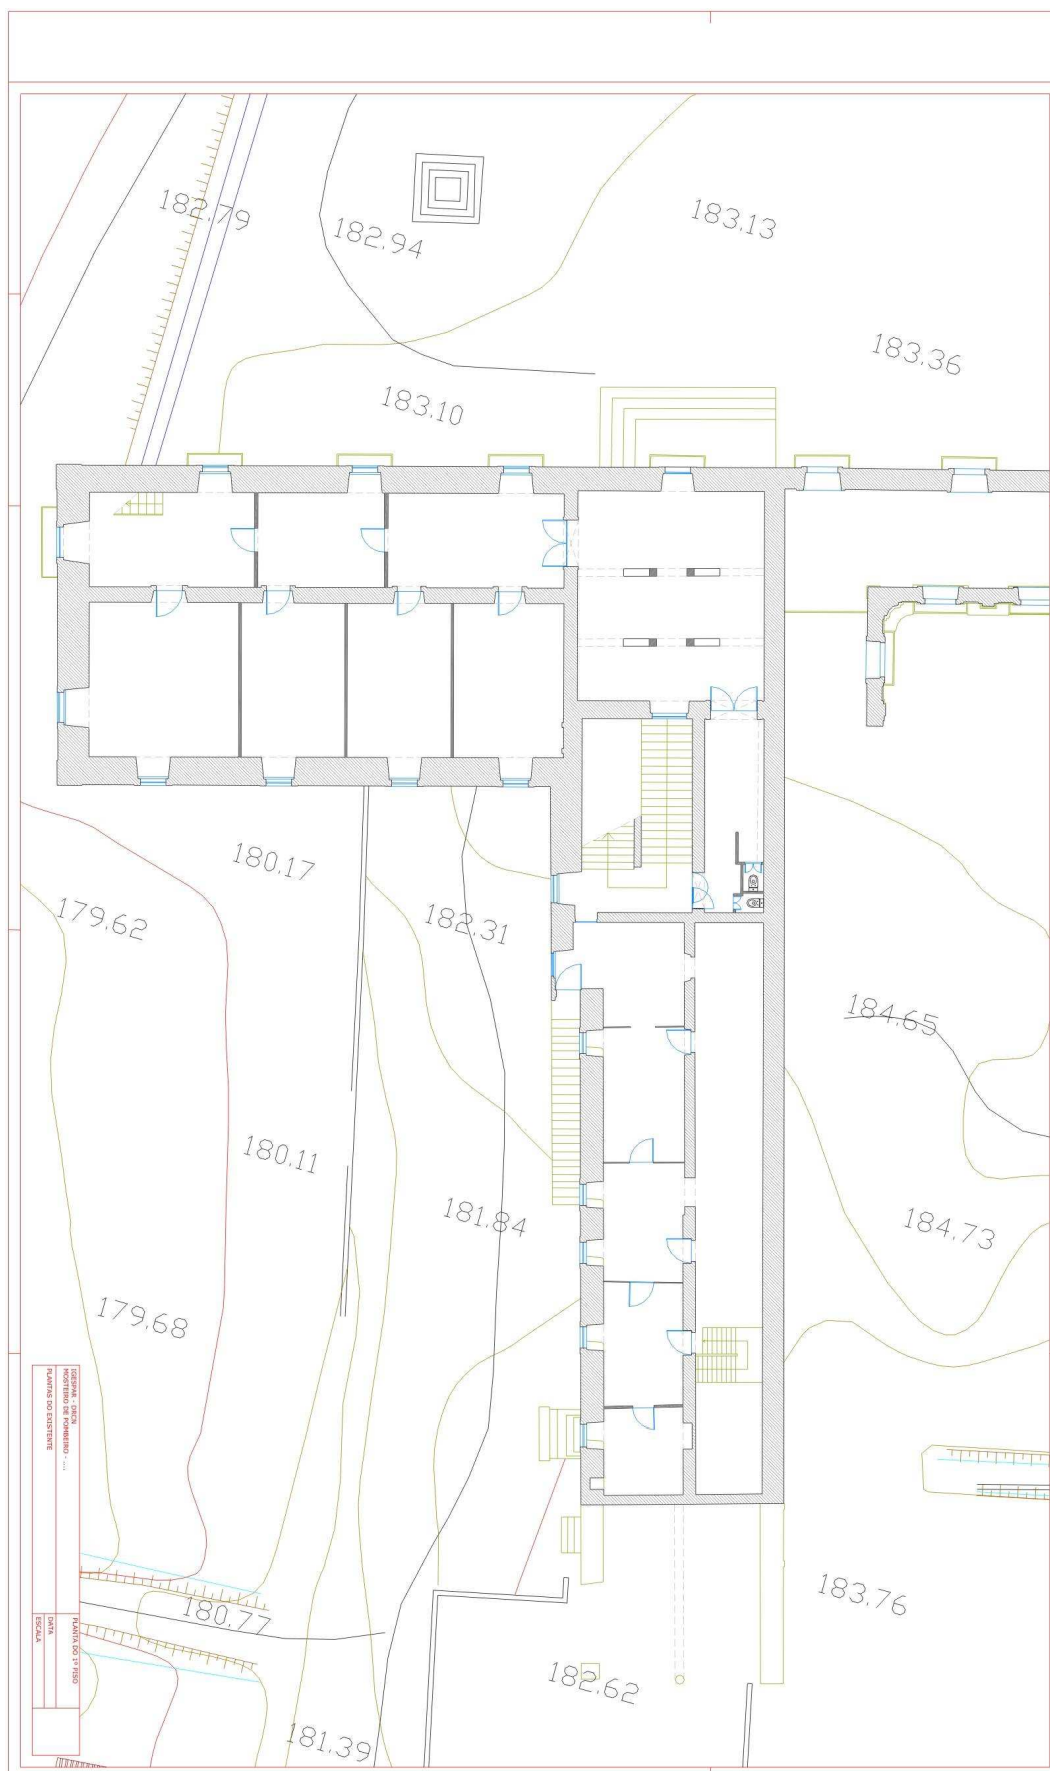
Planta do primeiro piso do edifício da ala ponte do Mosteiro de Santa Maria de Pombeiro (sem escala).
